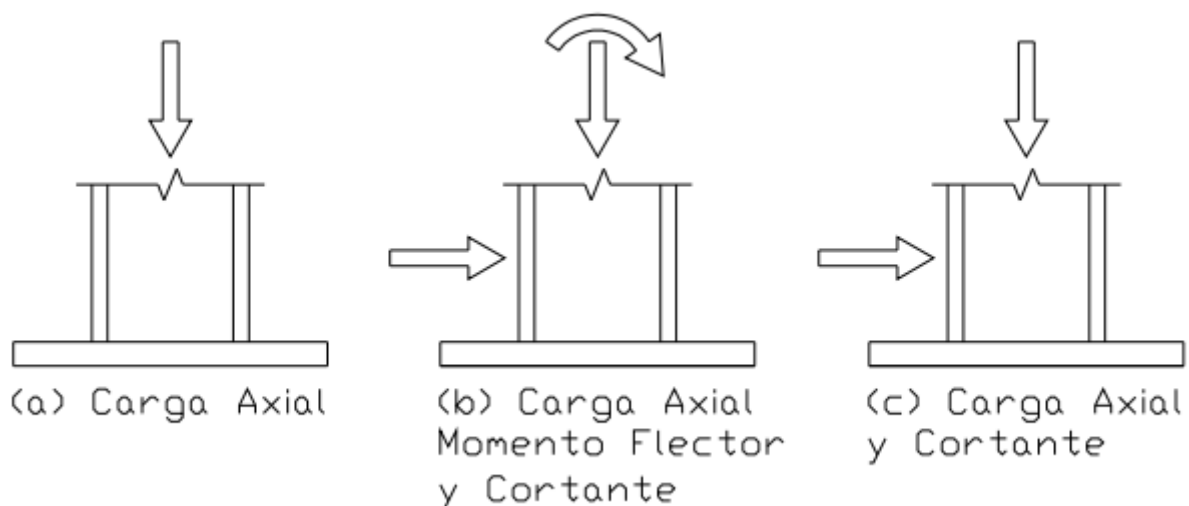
Casos de diseño de placas base para columnas de acero [12]
